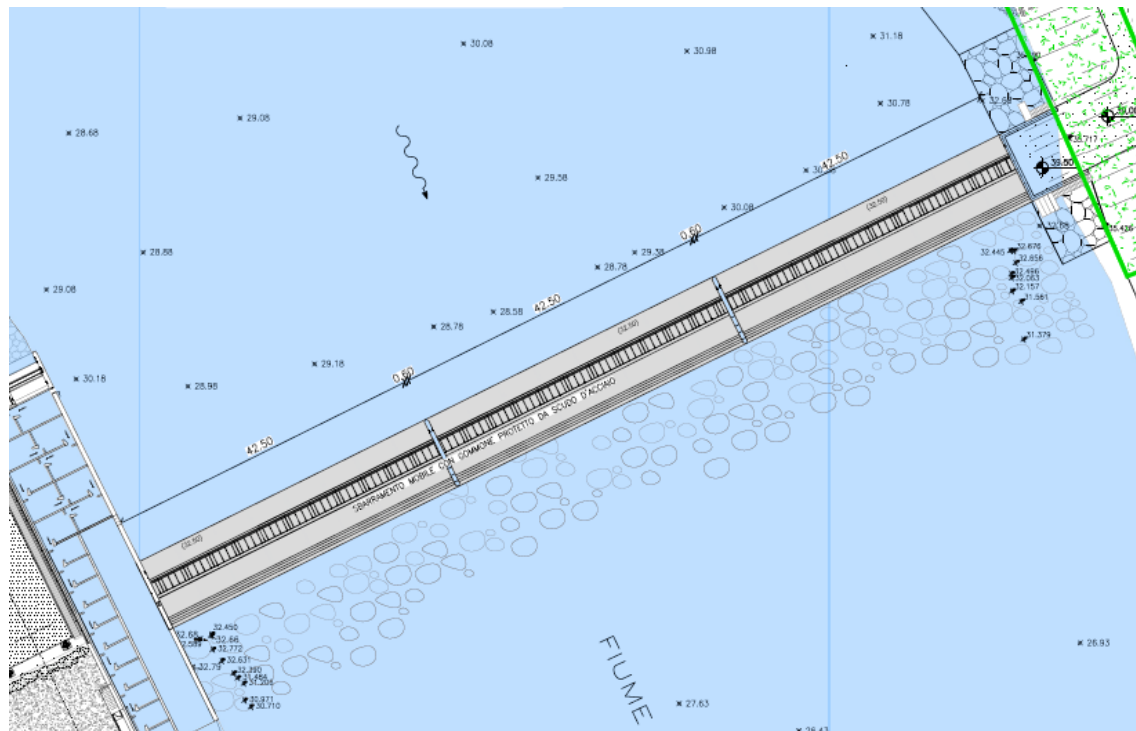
Planimetria di progetto con lo sbarramento sul fiume Adda in evidenza
